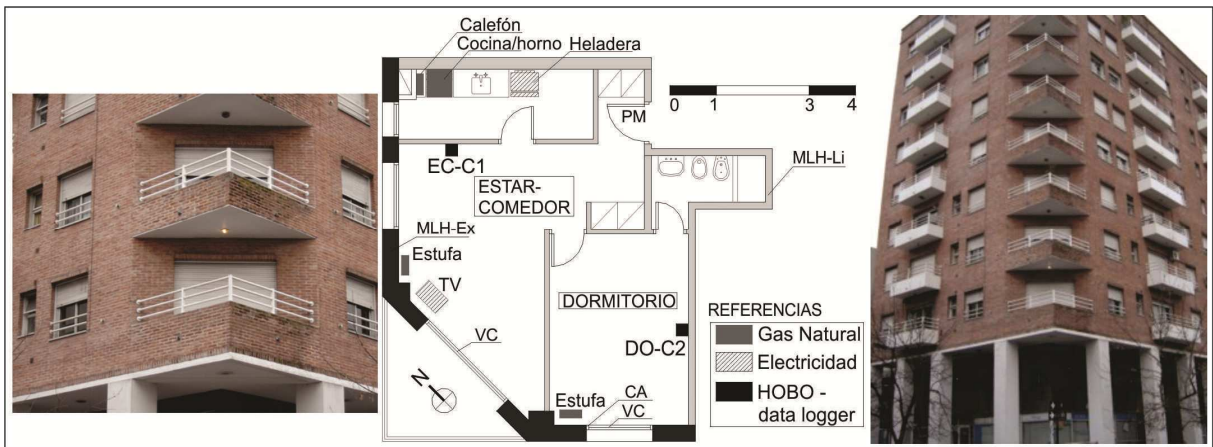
Dpto.2 – Planta e imágenes exteriores. Indicación principales materiales y equipamiento.
